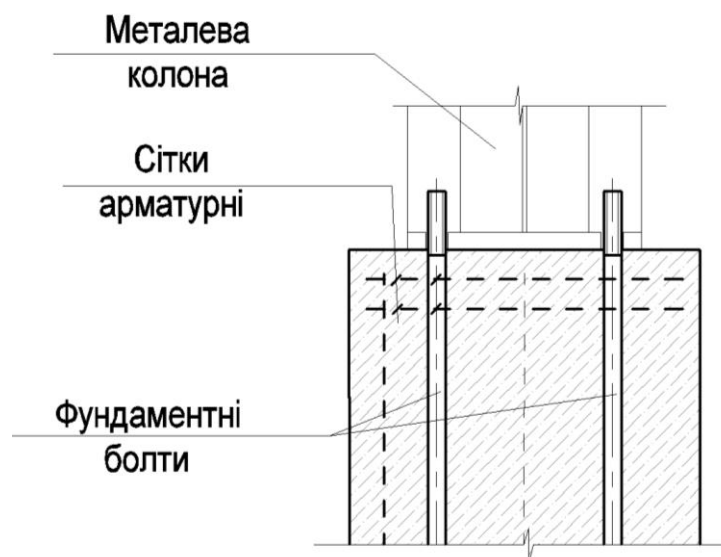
Конструкція стику фундаменту з металевою колоною
